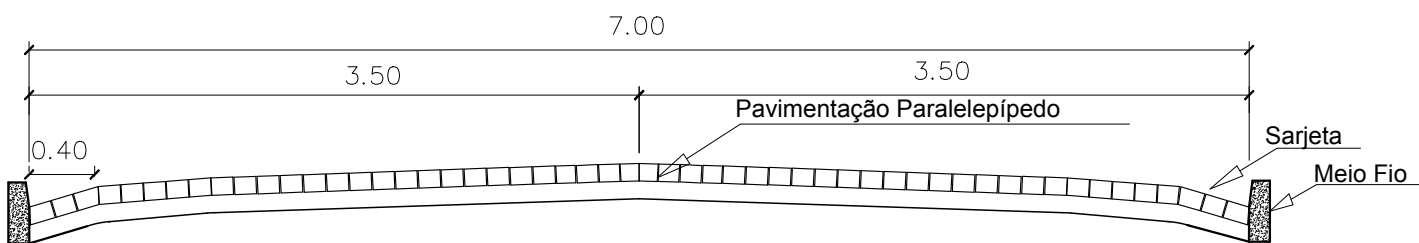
PAVIMENTAÇÃO SEÇÃO TIPO DAS RUAS
